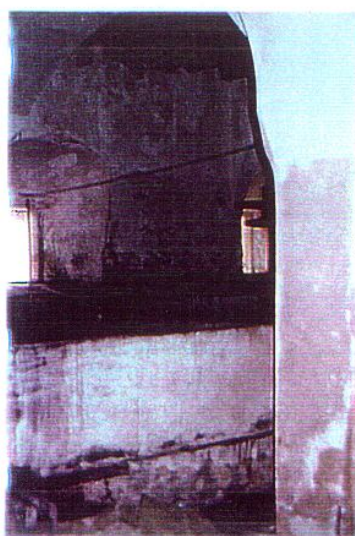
Quinta do Vimeiro, vista de um pilar e tecto do lagar .
